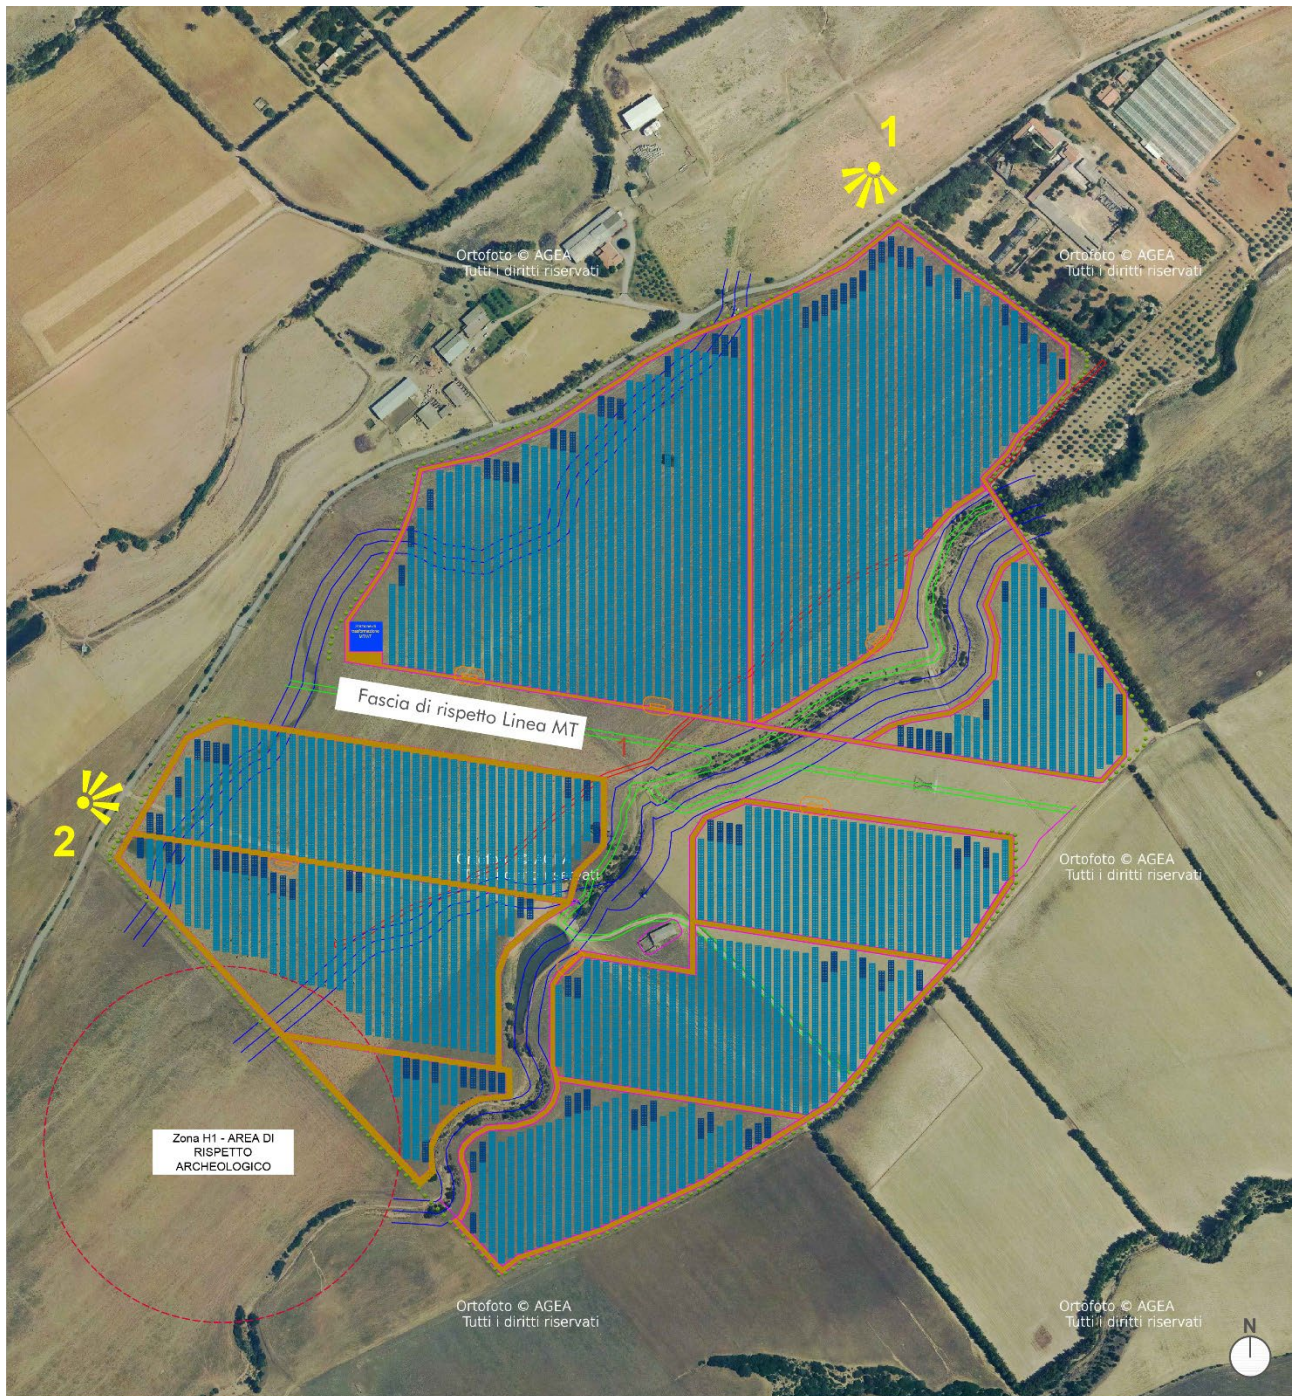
Planimetria punti di ripresa fotografica delle aree di progetto (Fonte Google Earth).
